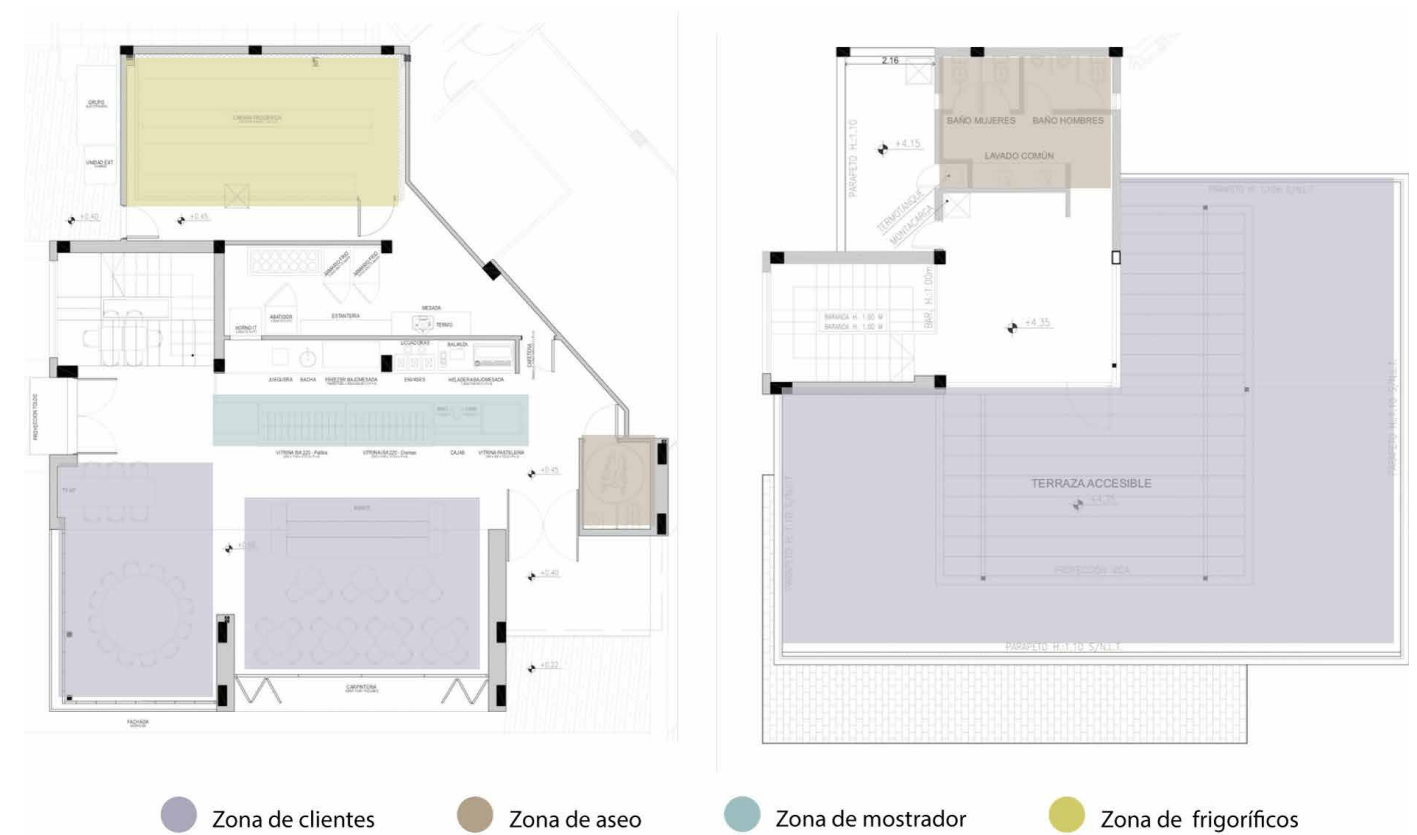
Zonificación planta baja y alta heladería Lucciano's
